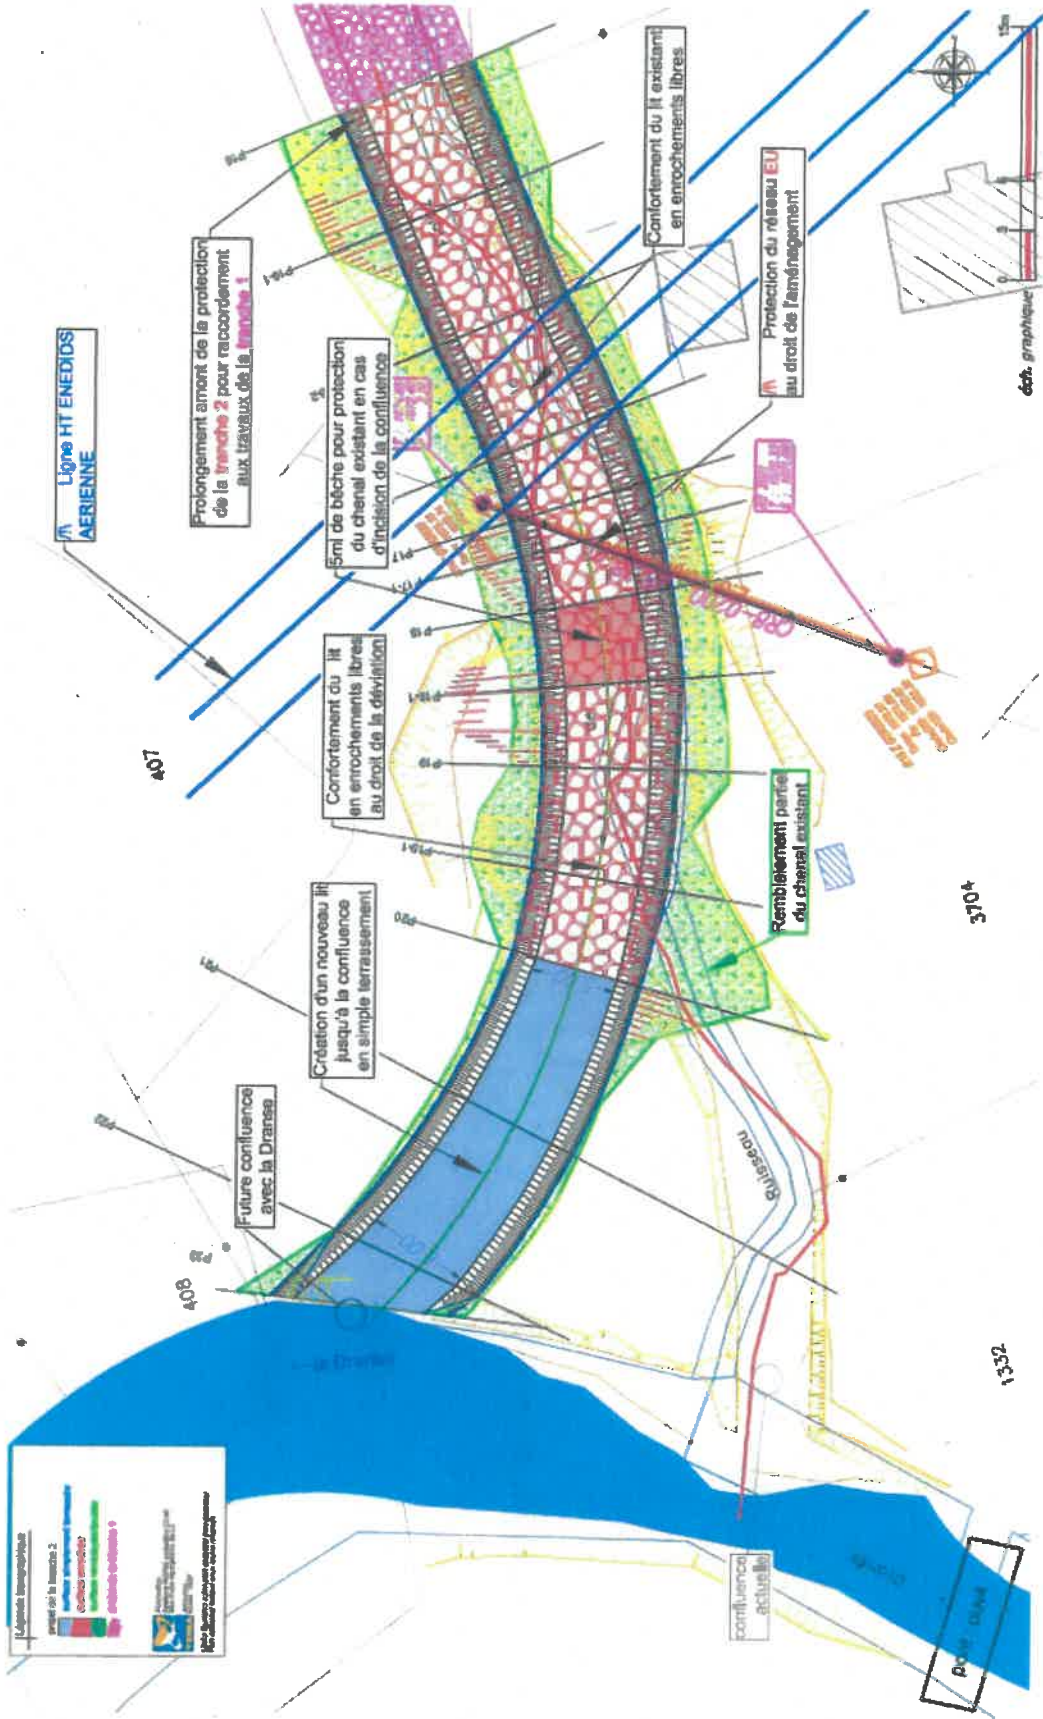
Vue en plan des aménagements projetés sur la Tranche 2
